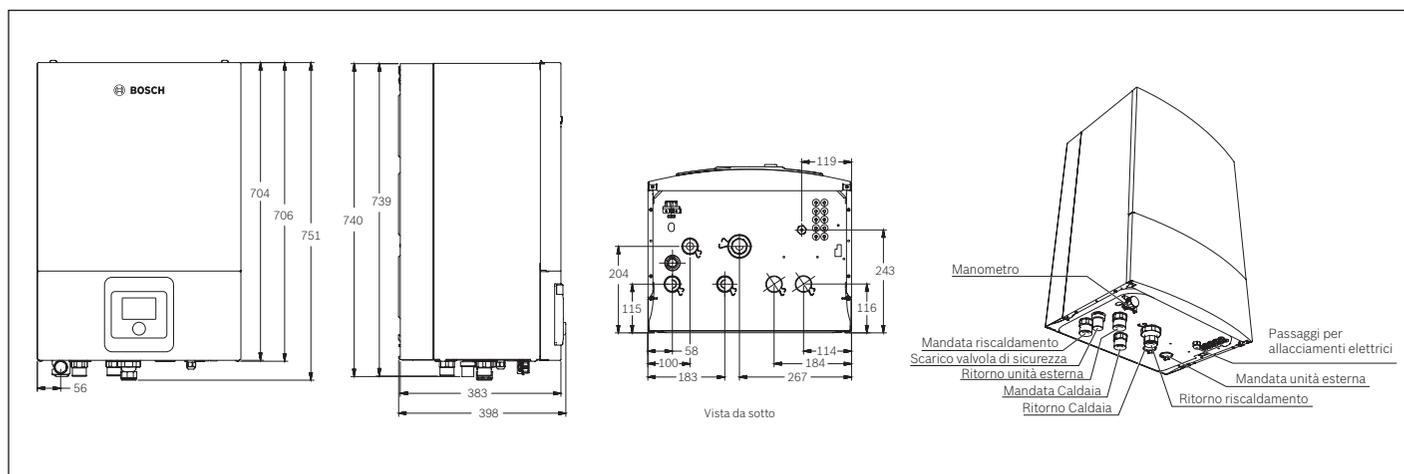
Dimensioni e attacchi collegamento unità AWB
